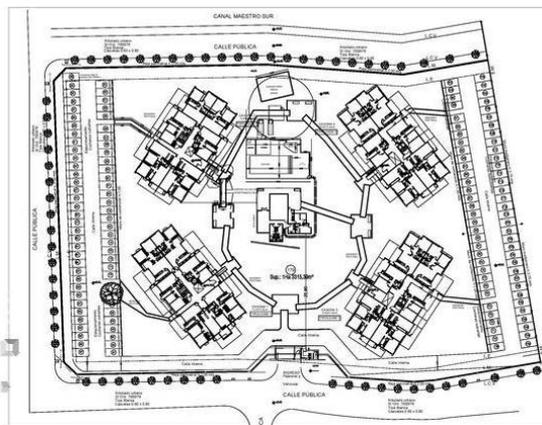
[Planta baja Conjunto Casonas de Manantiales, 2009. Tipología de agrupamiento] Fuente: <http://bit.ly/2UQz5vW>
